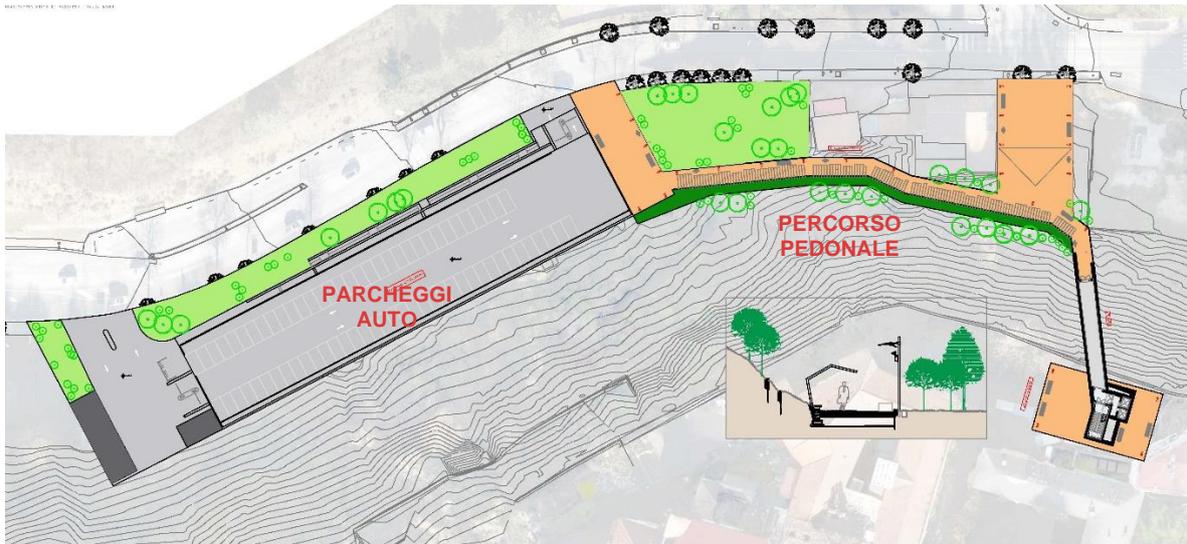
PLANIMETRIA DEL PROGETTO DI VARIANTE CON DESTINAZIONI D'USO
